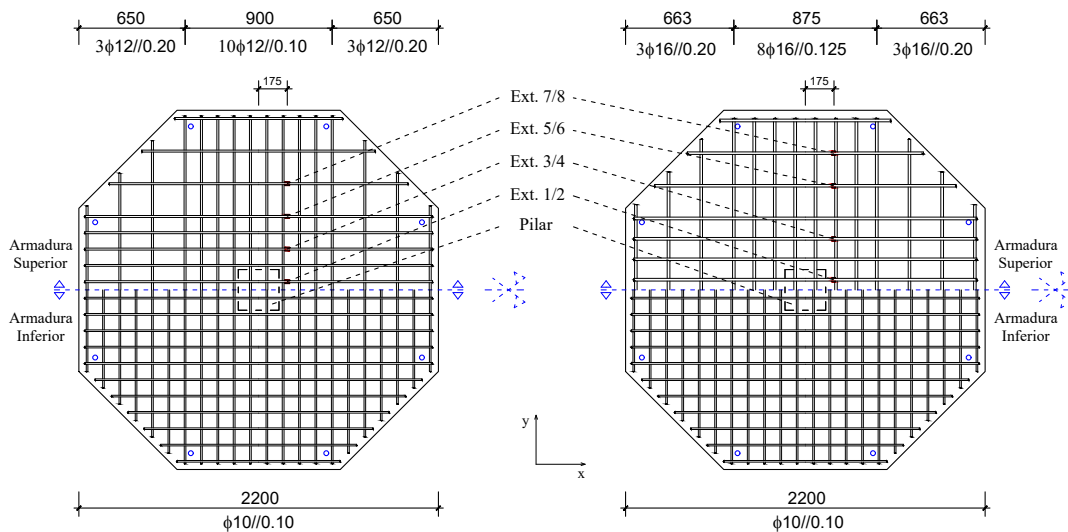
Esquema das armaduras longitudinais dos modelos com utilização racional de BRFA (desenhos sem escala e dimensões em mm).
